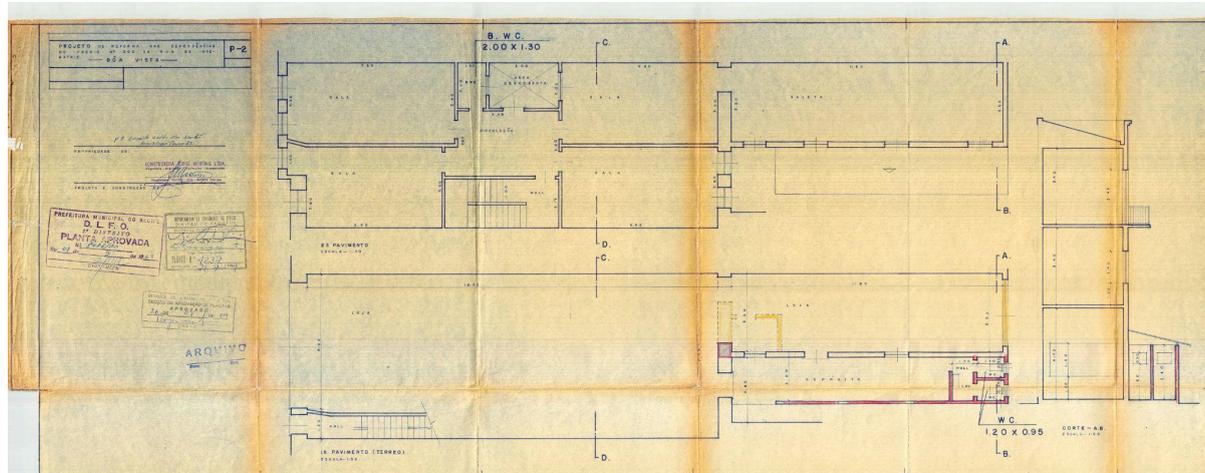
Plantas baixas do primeiro pavimento, do térreo, e corte AB. Notar diminuição do recuo lateral da porção posterior da edificação, para ampliação do salão da loja e relocação do depósito. Fonte: Diretoria de Controle Urbano do Recife (DIRCON)
